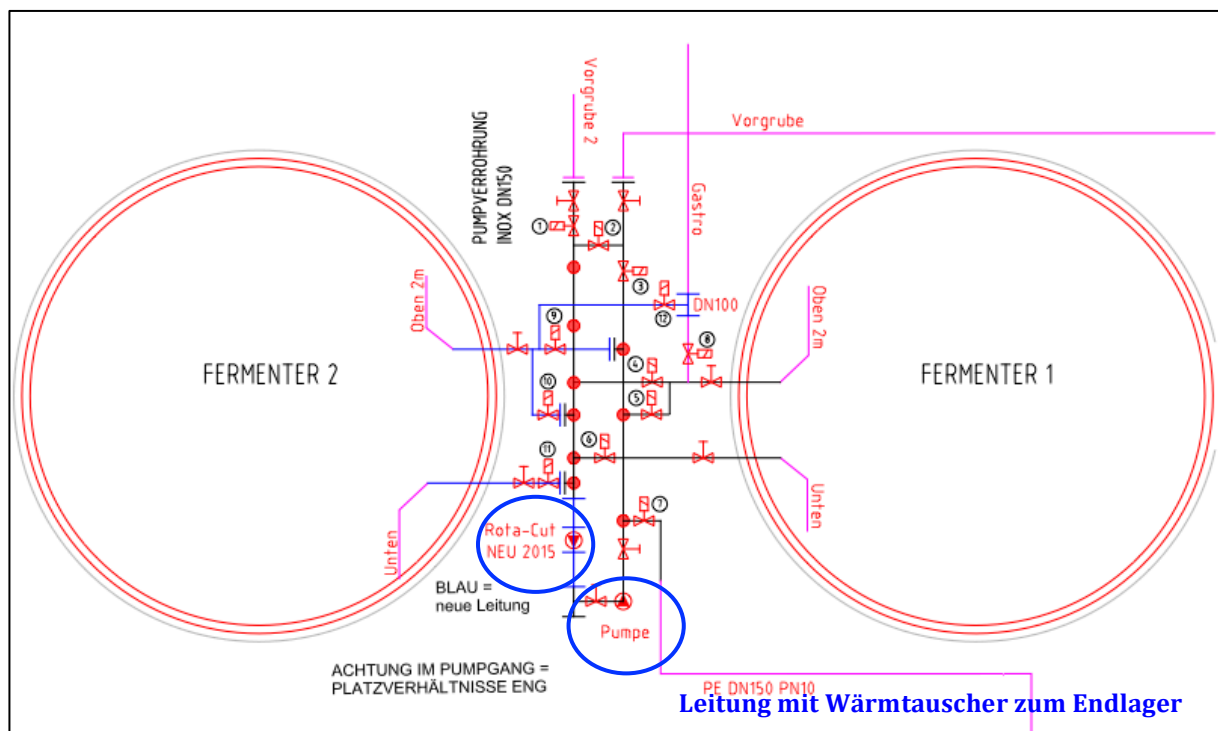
Gülleschema mit Rotacut und Pumpe (Quelle: Schweizer AG.)
